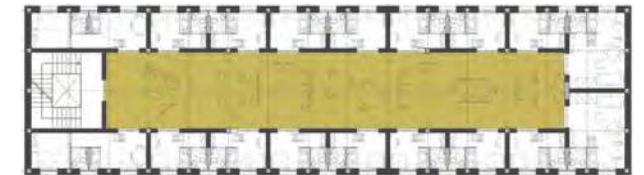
Grundriss eines Geschoßes im Co-Being House
